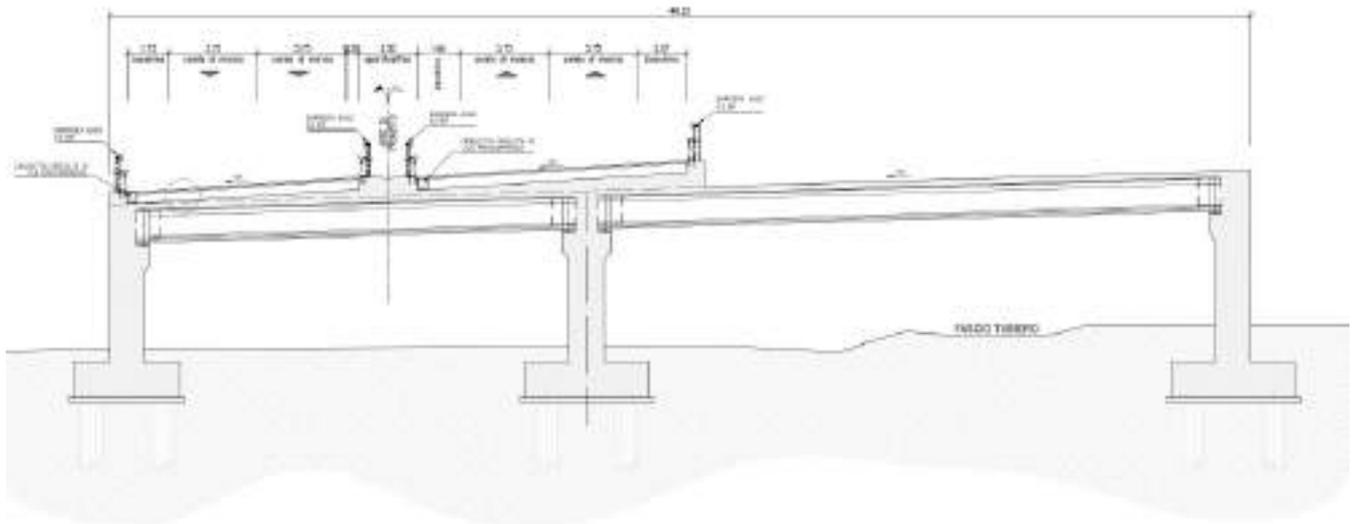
Sezione tipo dell’asse principale su opera di attraversamento.
